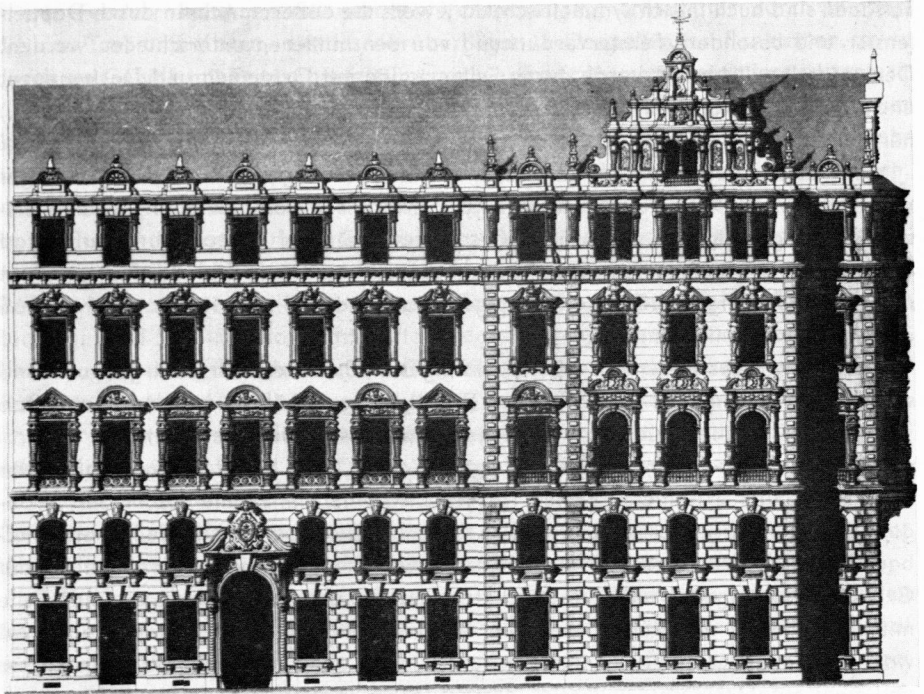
Das Wohnhaus der Familie *Carl Schlimp* in Wien III, Strohgasse 24, 1884–1885 erbaut; die Fassadendekoration ist nicht mehr erhalten
